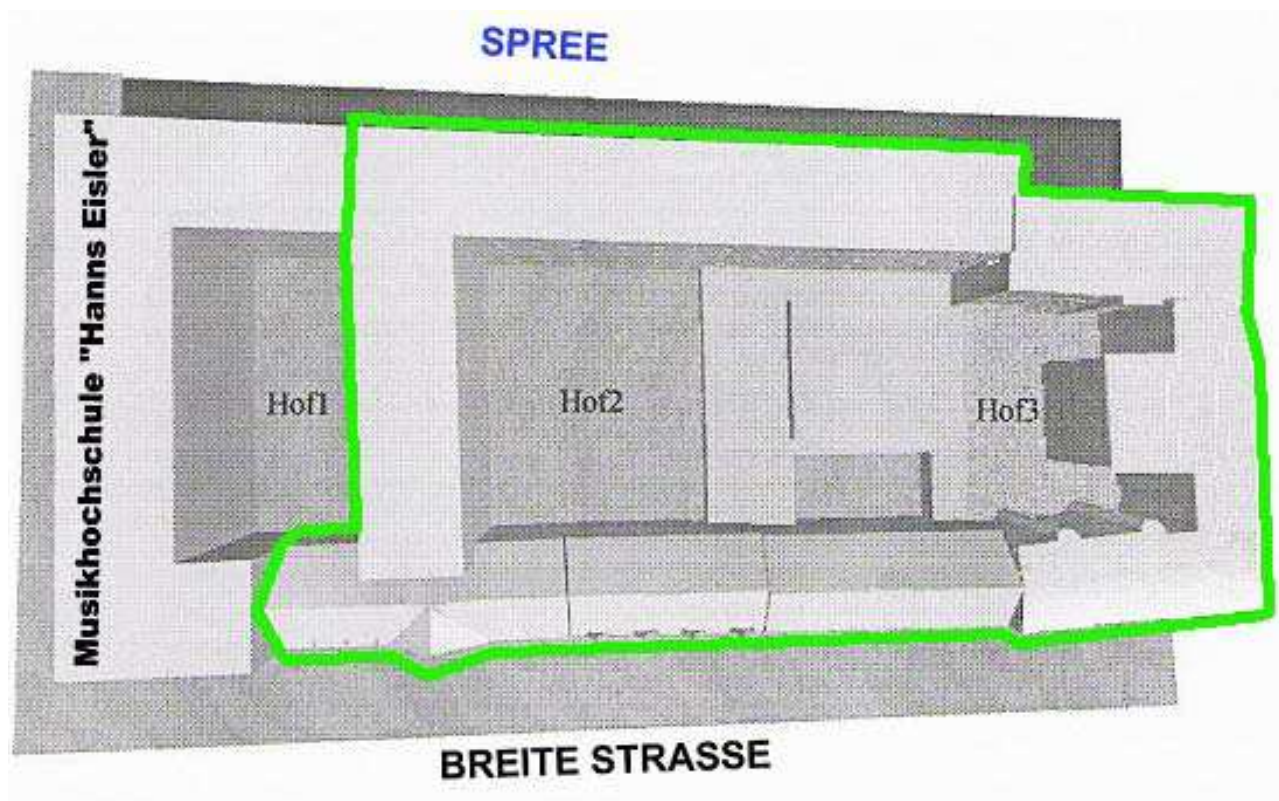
Gebäudekomplex der Zentral- und Landesbibliothek Berlin, Breite Straße 30-36, 10178 Berlin <sup>(grün)</sup>
